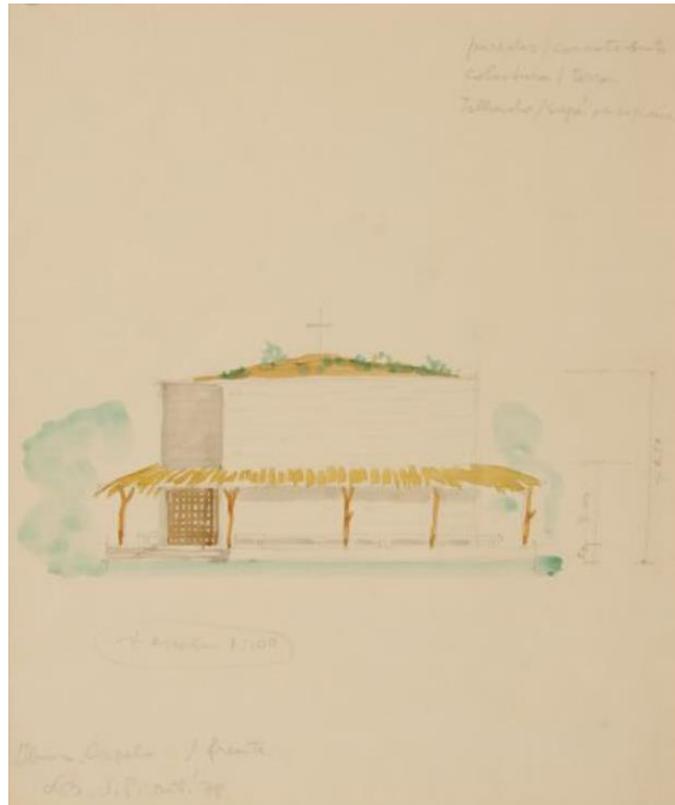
alzado frontal de la Capilla Santa María dos Anjos, 1978, archivo Instituto Bardi
